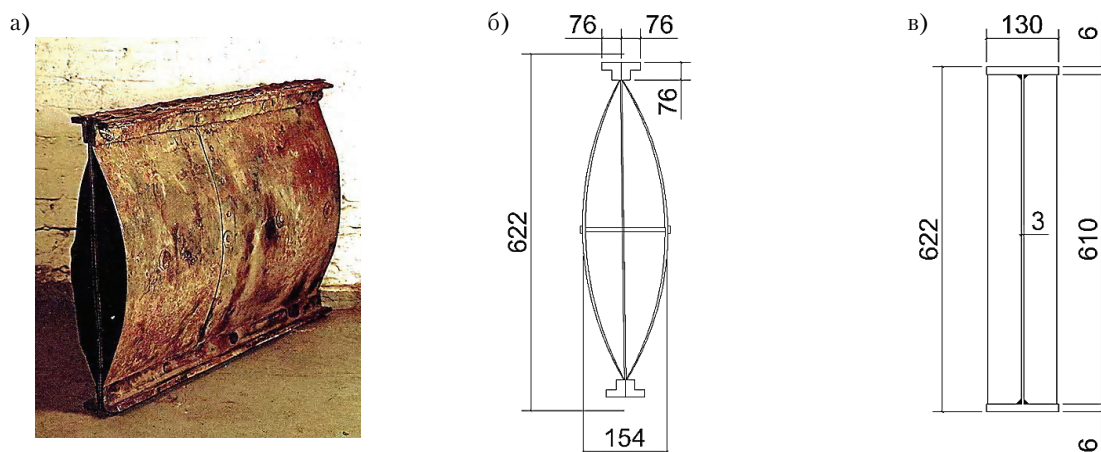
Эллипсная балка: а) фрагмент эллипсной балки; б) поперечное сечение эллипсной балки; в) тонкостенная сварная двутавровая балка
